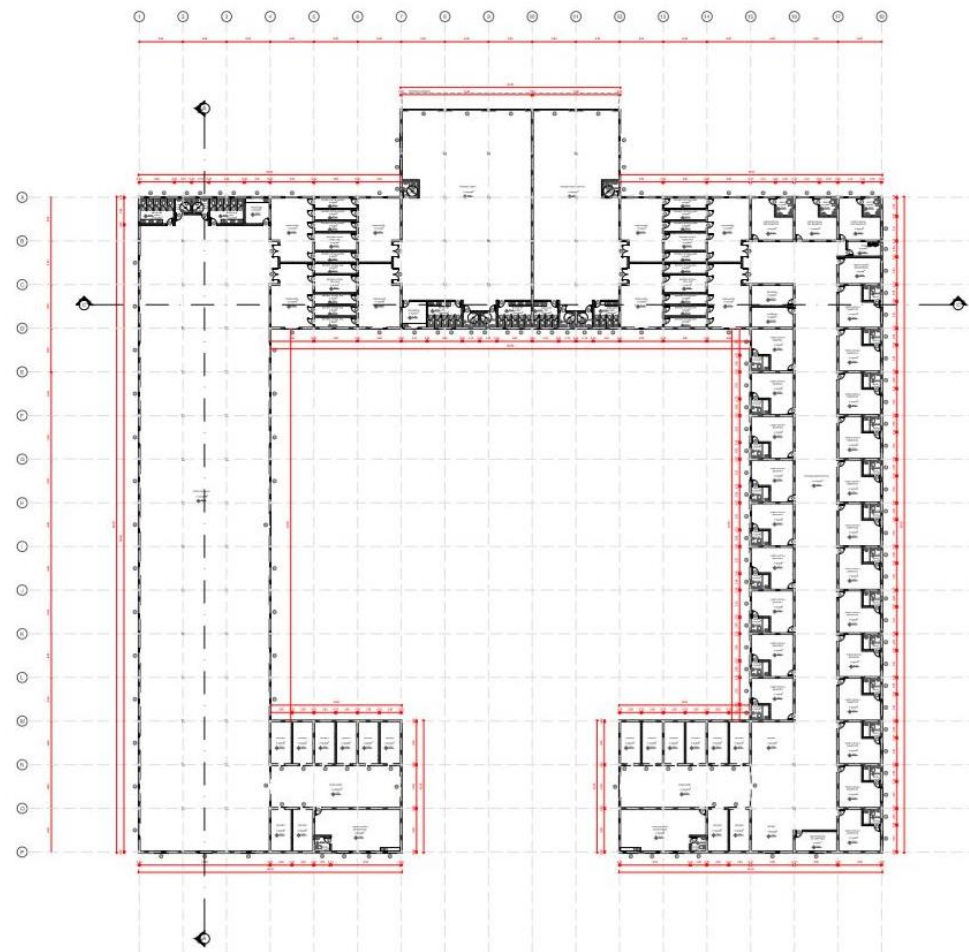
Planta técnica – Fonte: Acervo Próprio
